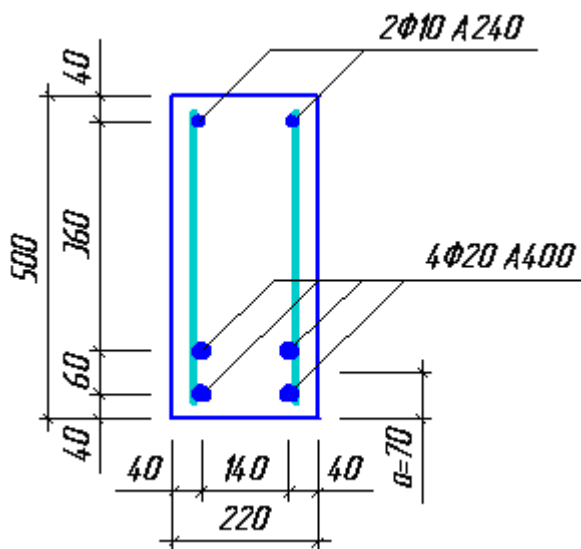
Армирование балки прямоугольного сечения с одиночной арматурой (пример).
